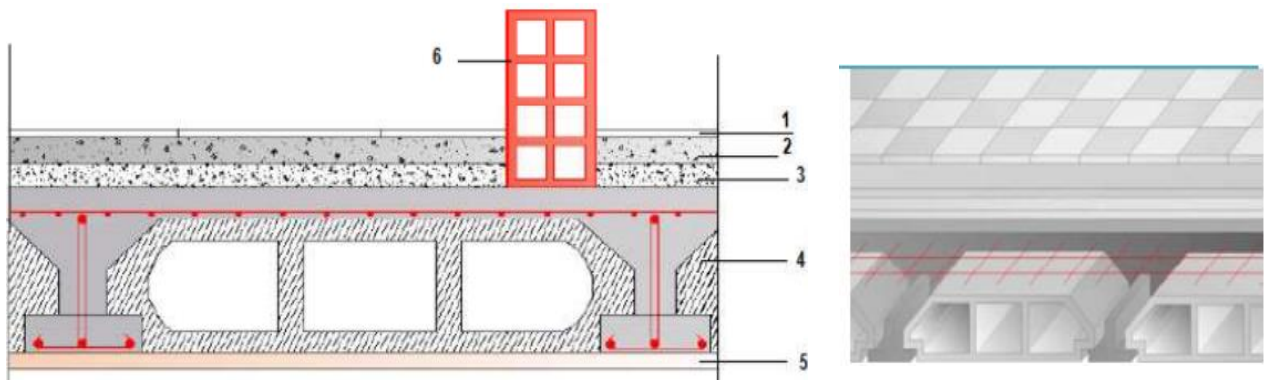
Coupe verticale d'un plancher à corps creux de niveau courant.
